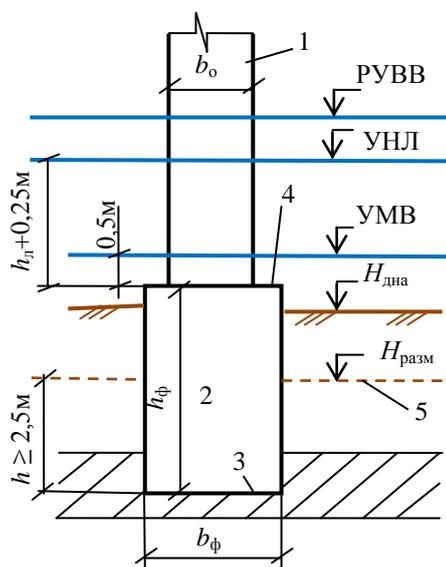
Разработка котлована для возведения фундамента промежуточной опоры в русле реки
